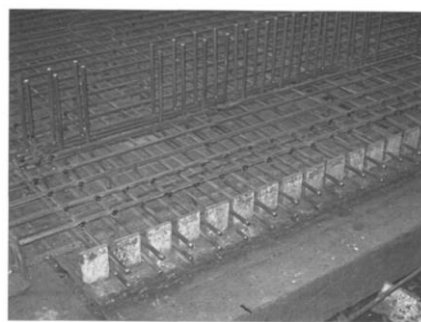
Стенд для изготовления сварных арматурных каркасов железобетонных секций понтона дока
